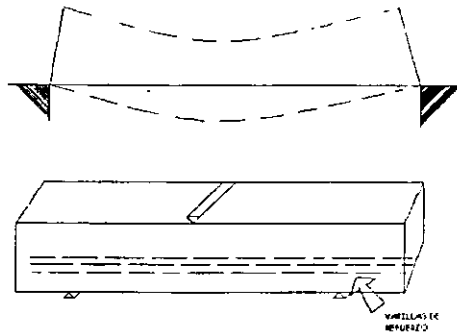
AL CARGARSE LA VIGA, LA ZONA INFERIOR QUEDA SOMETIDA A TENSION, POR LO TANTO SE COLOCAN VARILLAS DE REFUERZO EN ESA ZONA PARA PROPORCIONARLE UNA MAYOR RESISTENCIA A LA FLEXION
